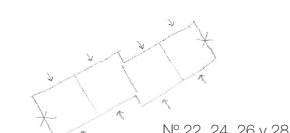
Bocetos en planta de la disposición de las construcciones situadas en la Rúa Moaña-Coia, nº 22, 24, 26 y 28 (autoría propia).
